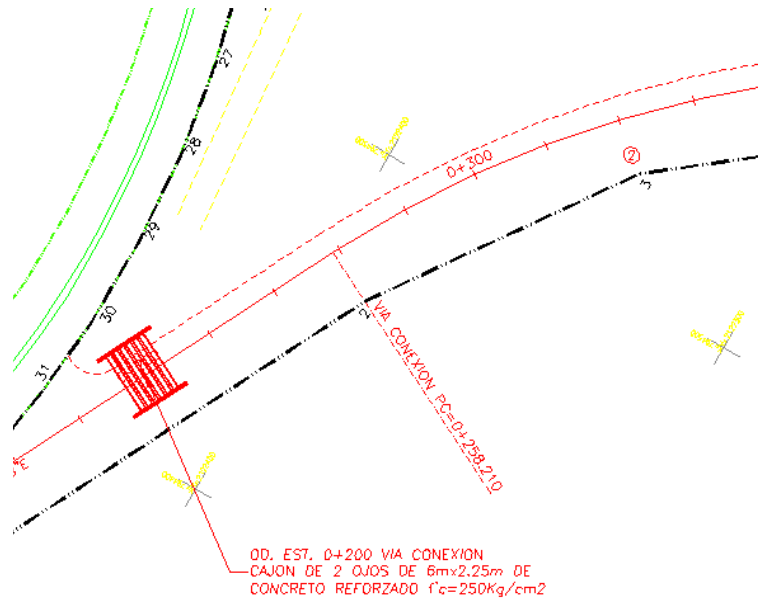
Obra de drenaje propuestas para la vía de conexión km 0+200.
